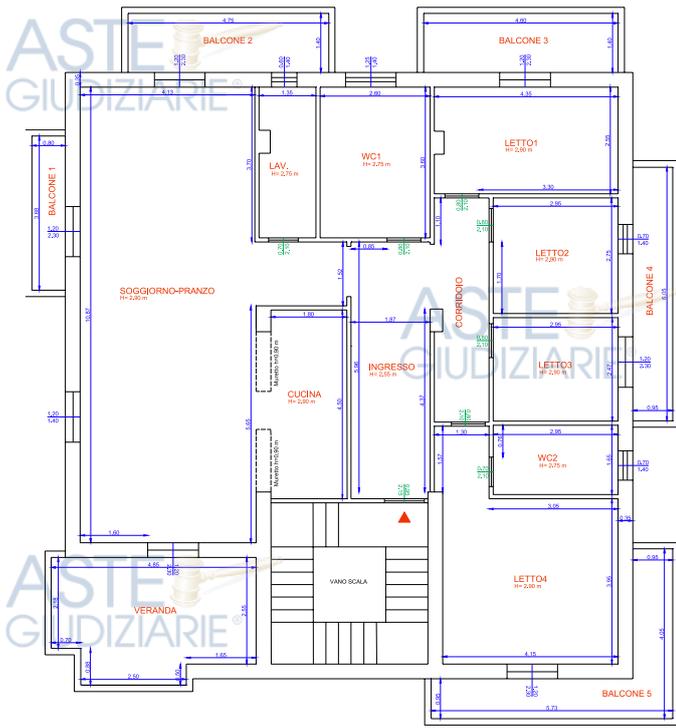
Raffronto planimetria stato di fatto e planimetria progettuale - BENE C - foglio 7, particella 825 subalerno 6
